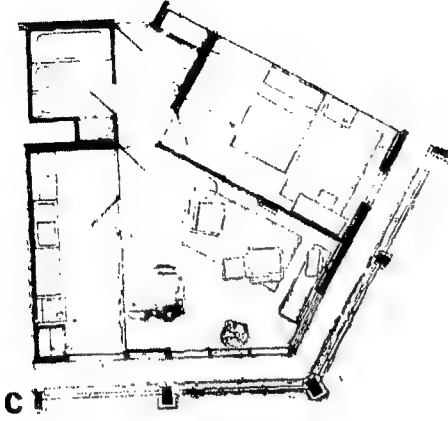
١٦ - ٣: مسقط أفقي للأدوار المتكررة للبرج.
